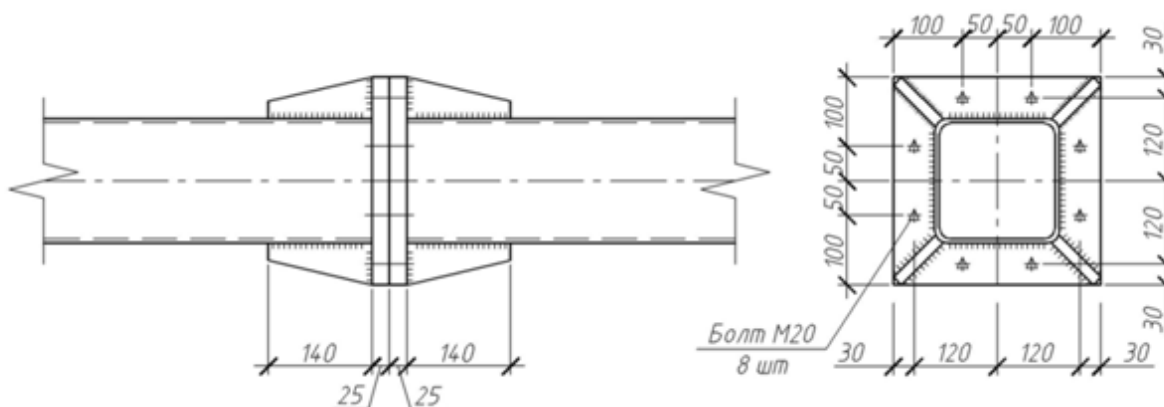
Решение типового узла фланцевого соединения нижнего пояса фермы
